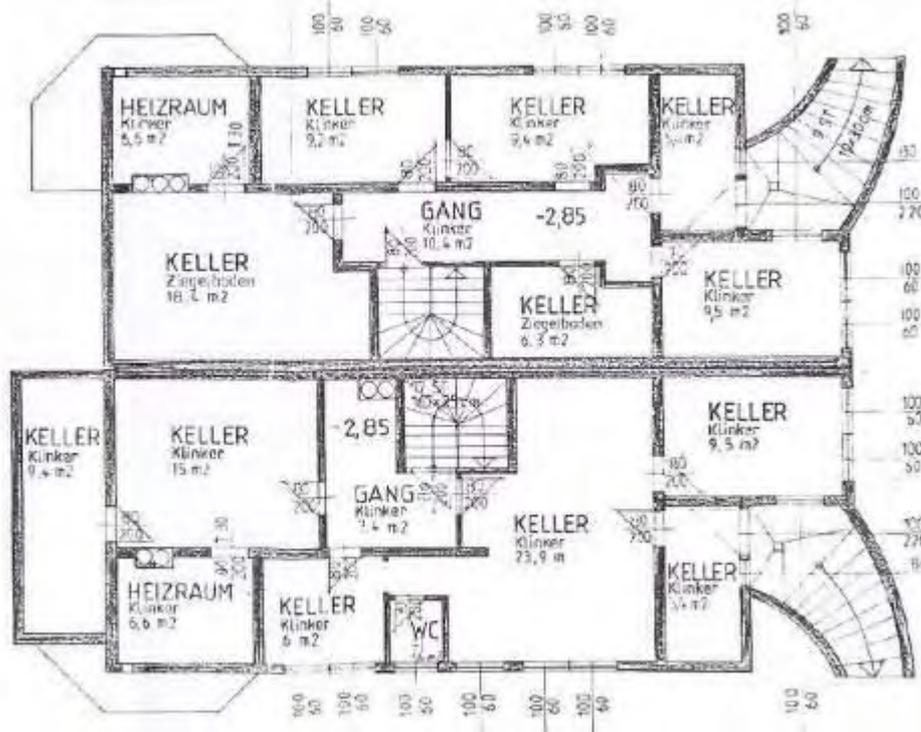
Grundriss Kellergeschoß „Haus K.“
